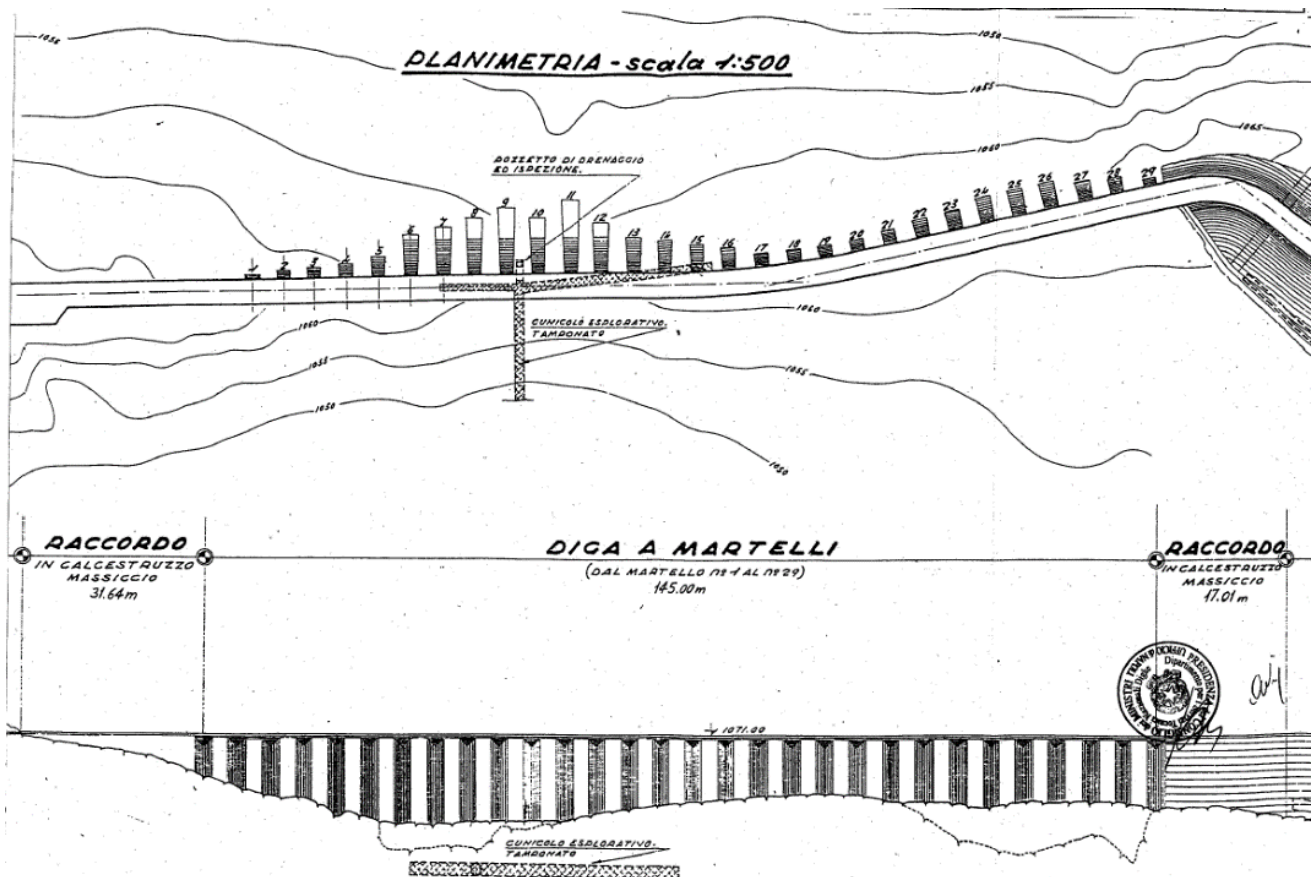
Invaso di Montagna Spaccata. Diga 2 muraria a gravità con speroni. Planimetria e Prospetto
